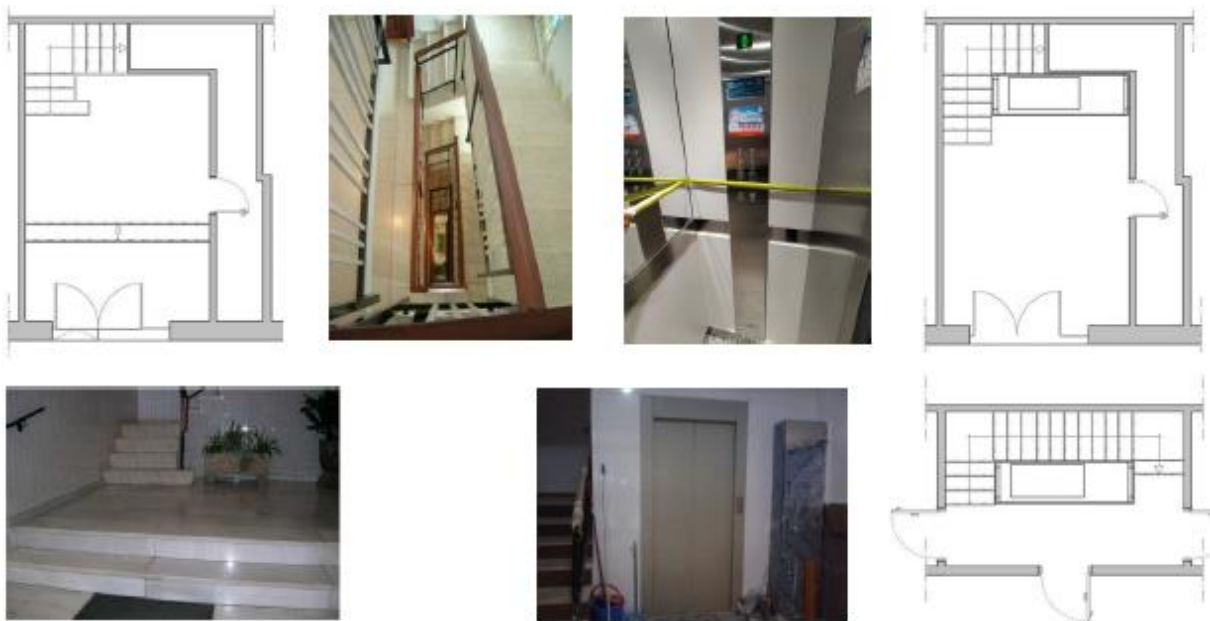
Ascensor en hueco de escalera: planos de plantas y fotografías, estado inicial y reformado.
